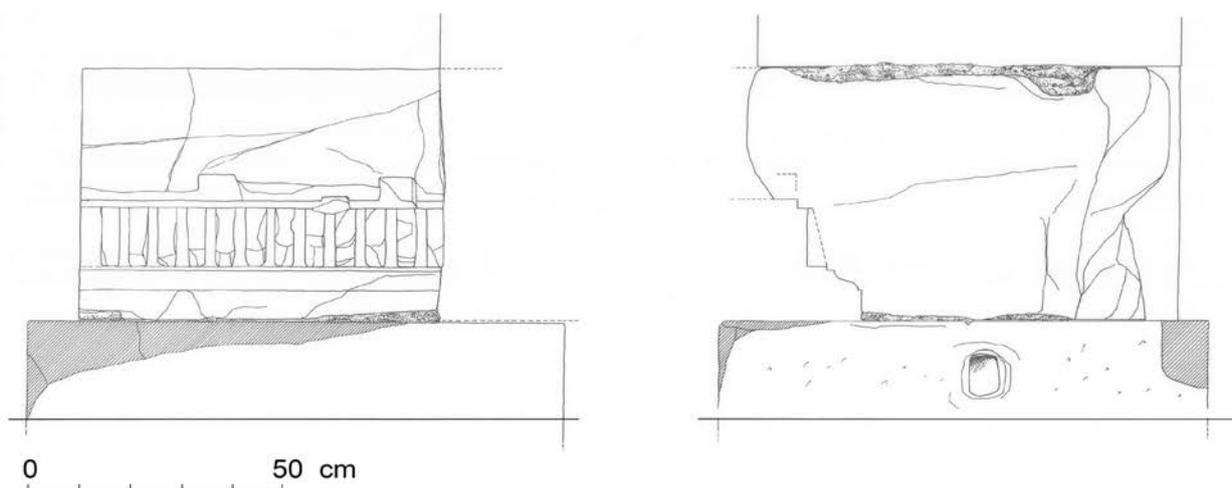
Spoleto, basilica di San Salvatore. Navata centrale, cornice NS 3 inglobata nella muratura del secondo pilastro nord, prospetto frontale e sezione.
